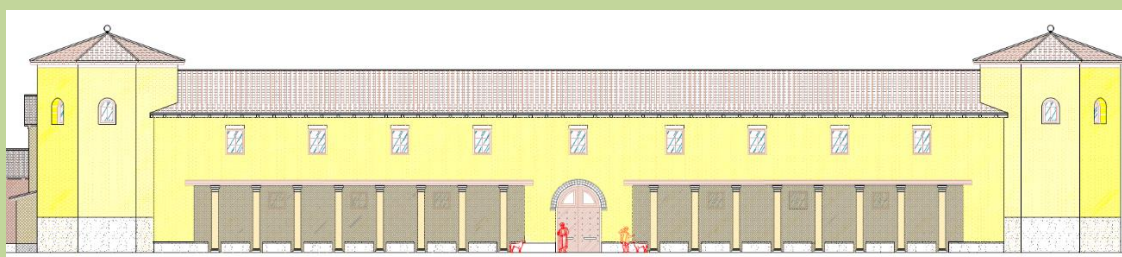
Alzado del ala sur de La Olmeda (reconstrucción virtual-II). CGS.
